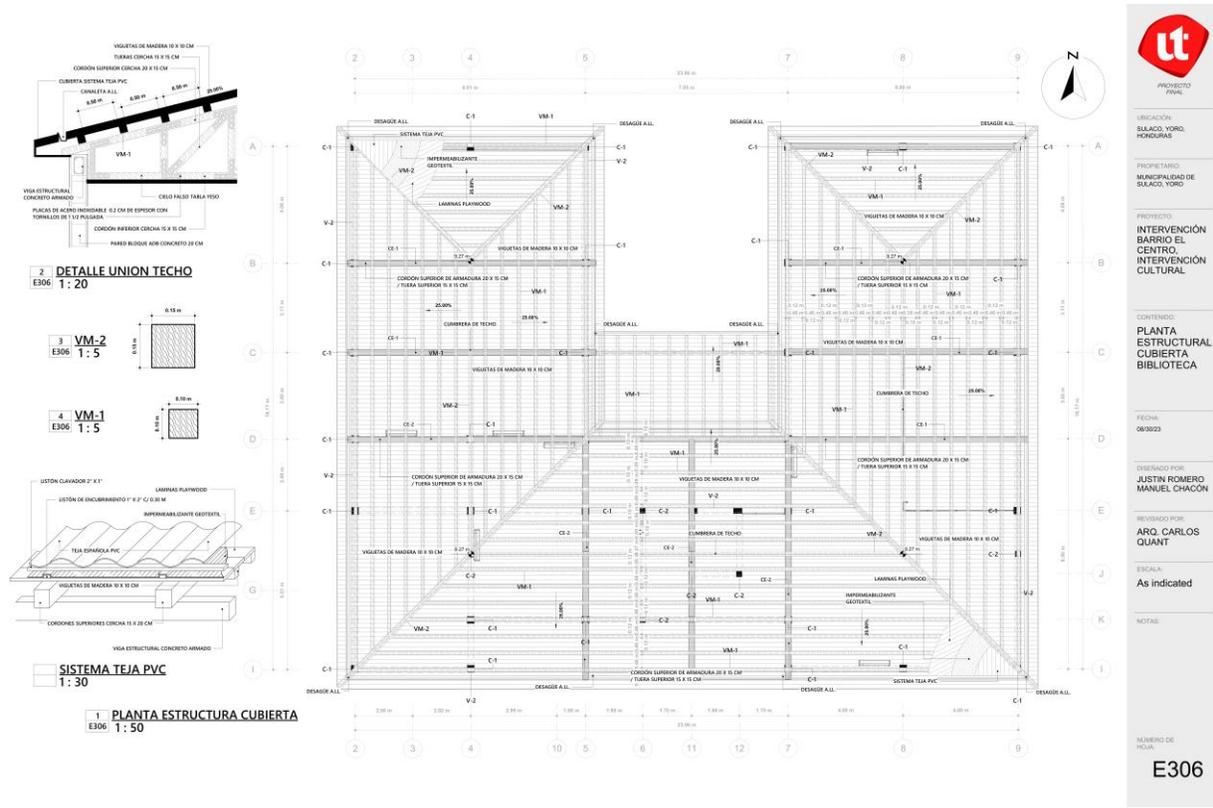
Planta de Estructura Cubierta | Fuente: elaboración Propia
